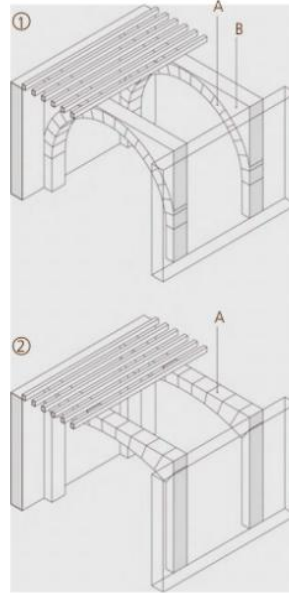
Exemple de plancher sur voûte en maçonnerie. [42]
